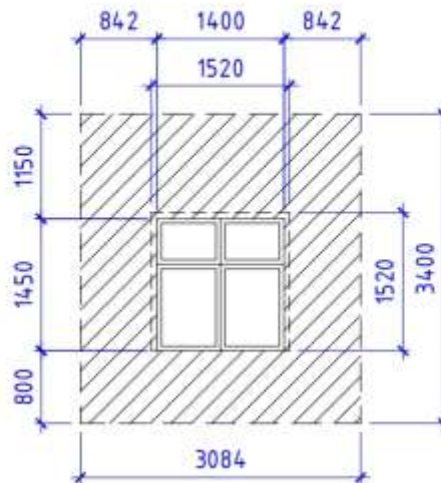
Фрагмент фасаду з розрахунковою ділянкою
